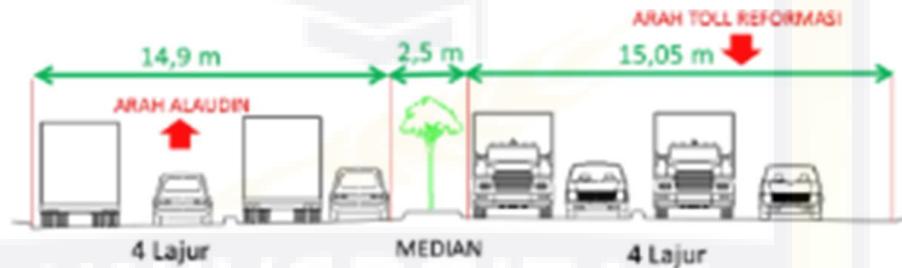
Ruas jalan terdampak langsung segmen AP.Pettarani
